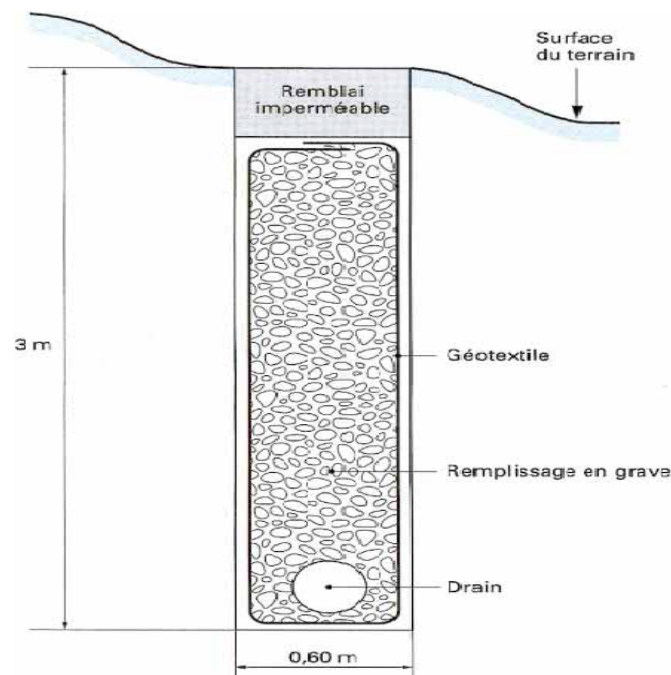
Coupe type d'une tranchée drainante (DURVILLE & GILLE, 2008).
